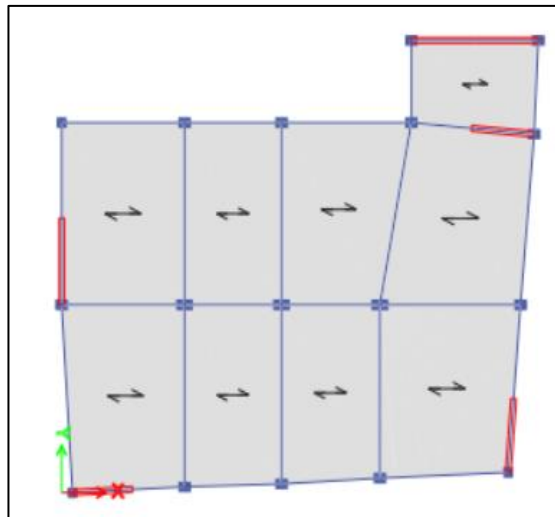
vue en plan du plancher terrasse (élévation R+12).
